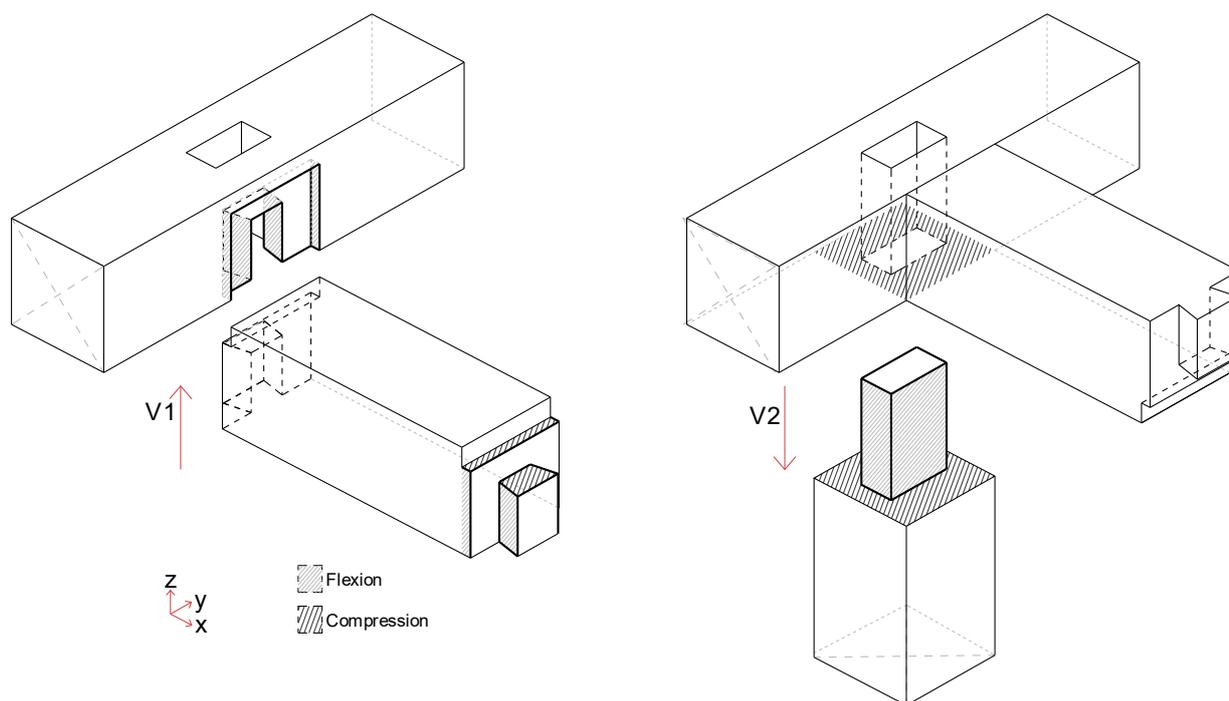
Le montant se trouve sous les poutres. Dans ce cas il est nécessaire de joindre en premier lieu les poutres et ensuite positionner les deux poutres assemblées sur le montant.
